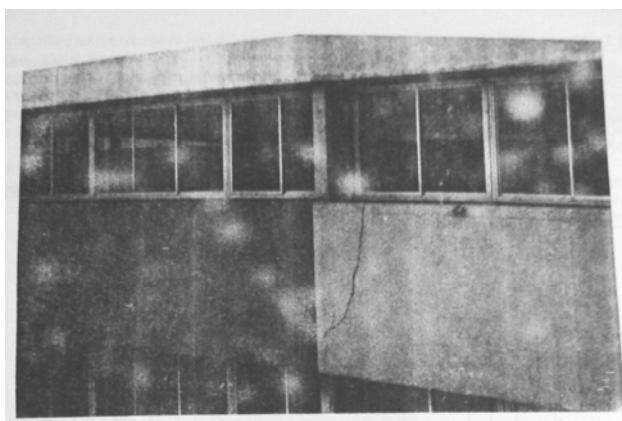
Fissuras de cisalhamento em viga alta, prevista no projeto como “parede de vedação”. (Fonte: THOMAZ)
